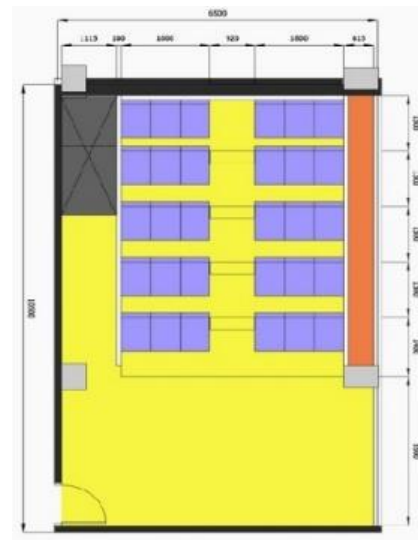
Denah Ruang Kelas 305 dengan Perabot
